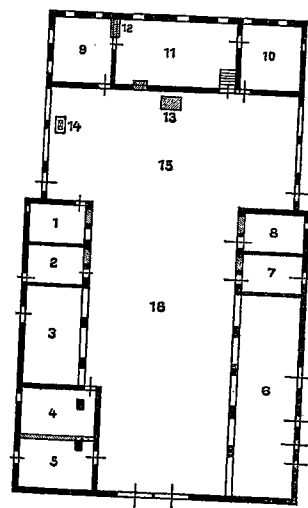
Grundriß des Hauses Meyer in Ummeln.
